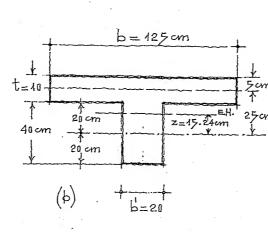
Corte de un entre-eje de la estructuro, (4).
